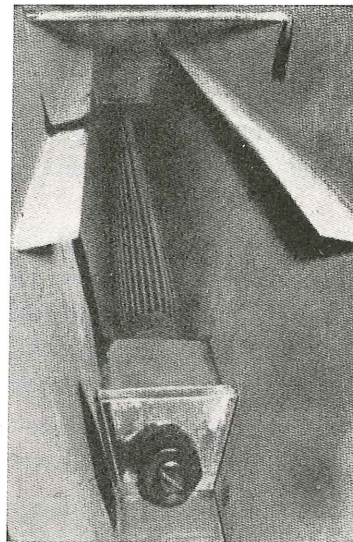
Detalle de la armadura de pretensado. Va protegida por una capa de pintura de minio.
